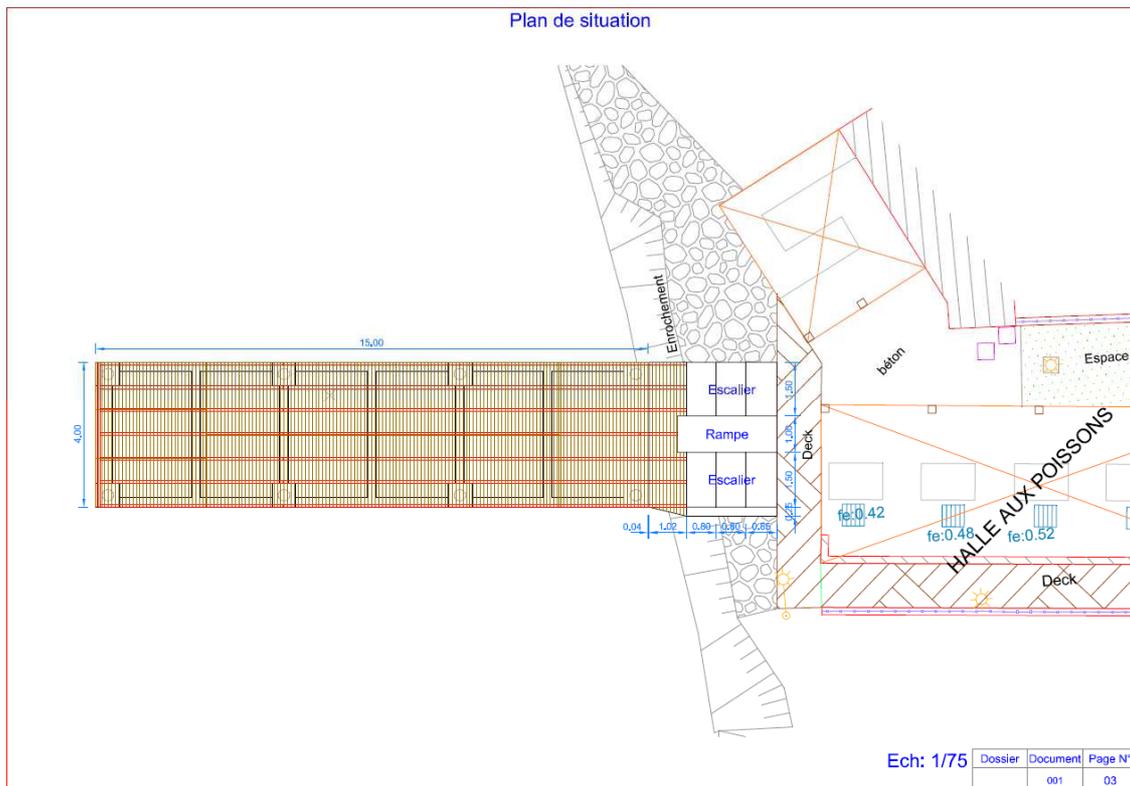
Plan de masse du ponton existant – source DOE ETPO Guadeloupe juillet 2012
